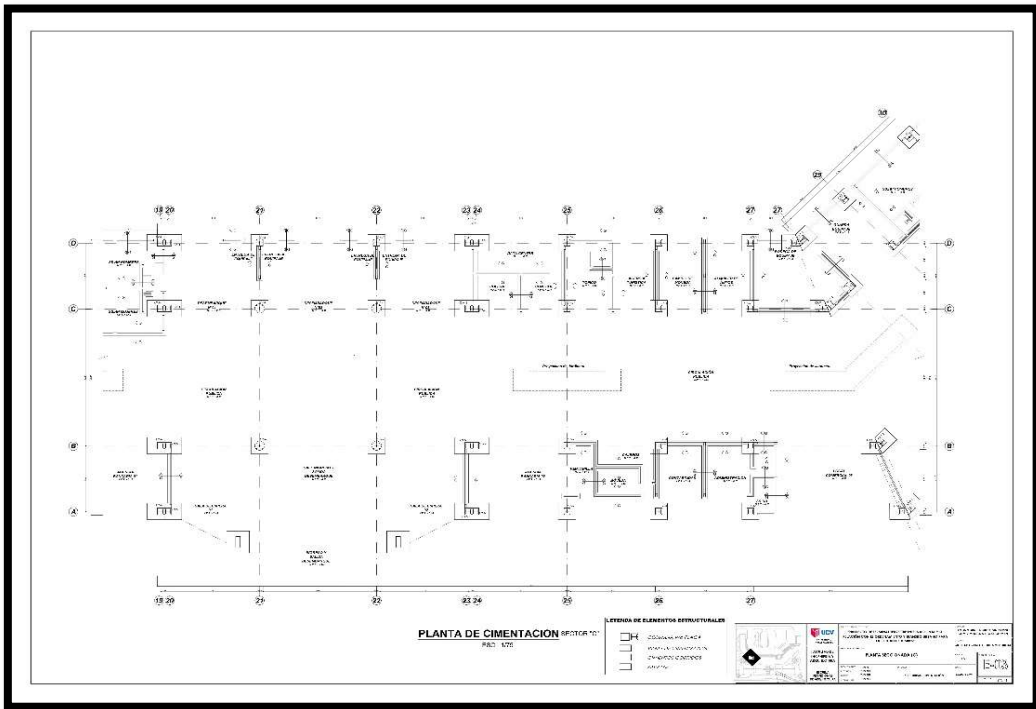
Plano de Cimentación Sector (C) Fuente: Elaboración Propia.
